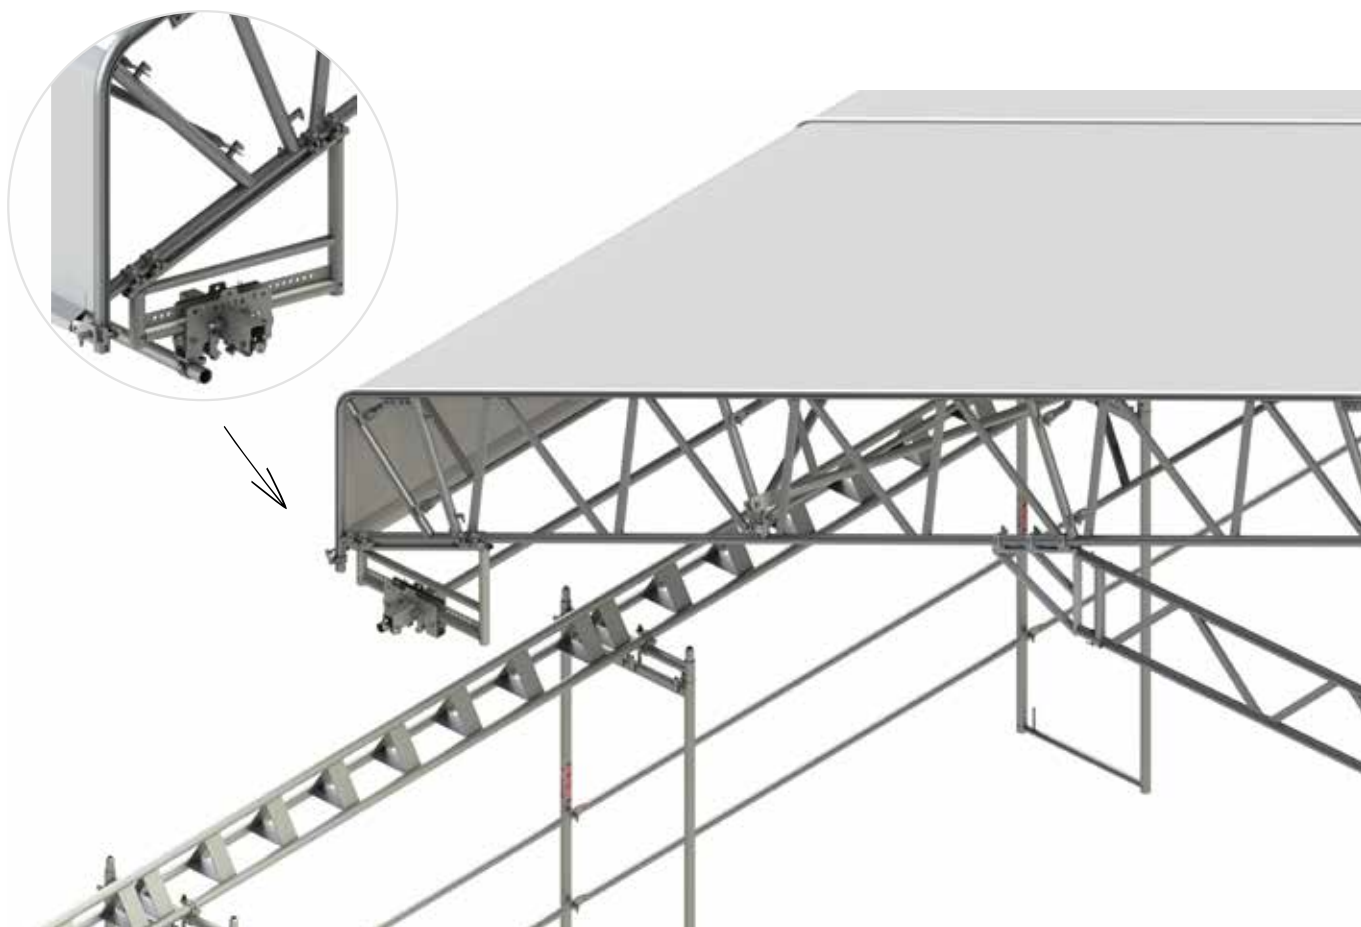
Przejezdna konstrukcja dachu systemu DELTA DACH.
